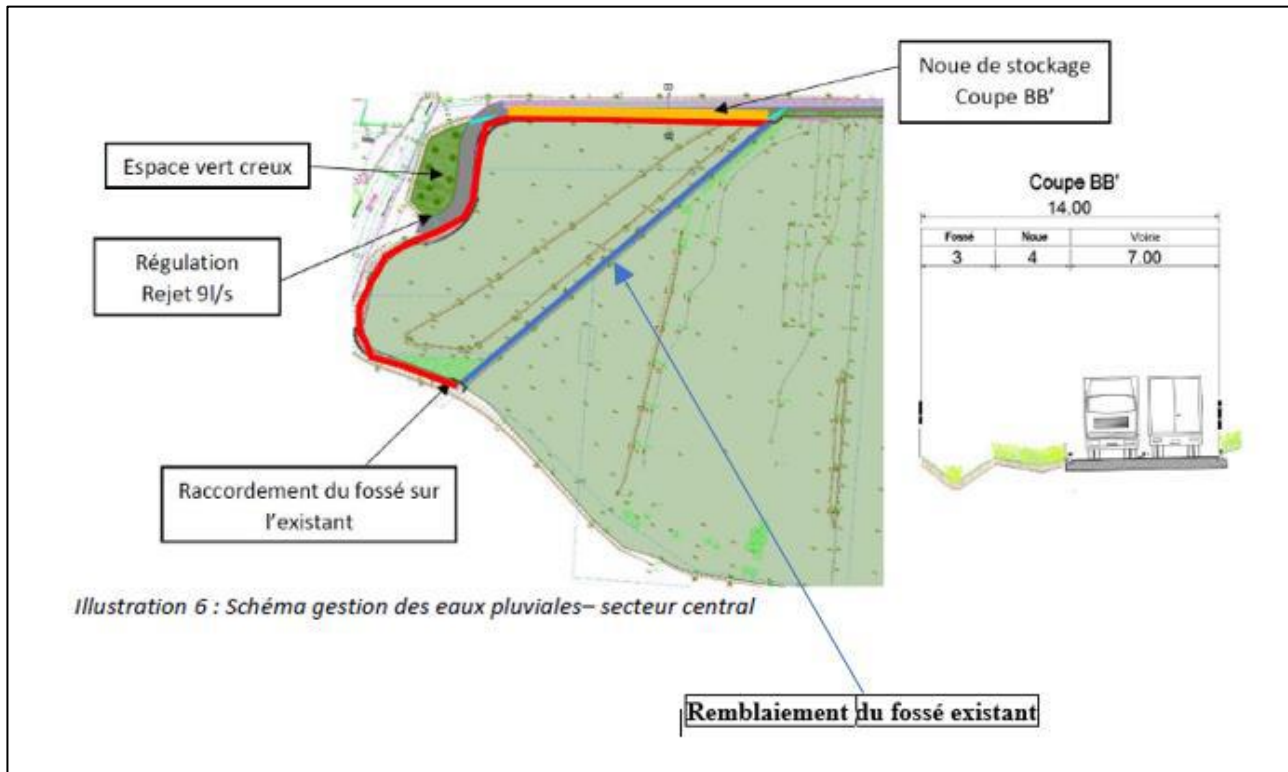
Schéma gestion des eaux pluviales- secteur central
